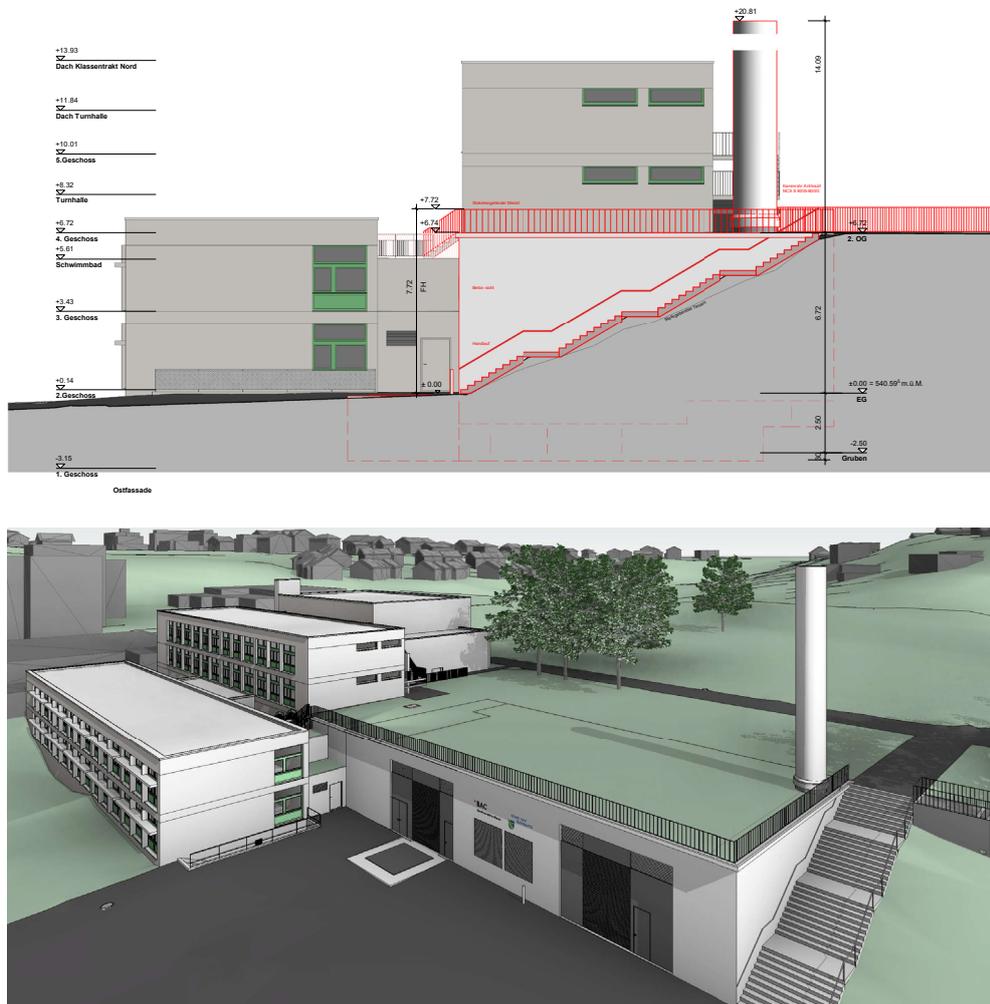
Geplante Fernwärmezentrale Selhofen. Ostfassade (oben) und Ansicht Südost (unten). Freier Massstab (f. M.).
